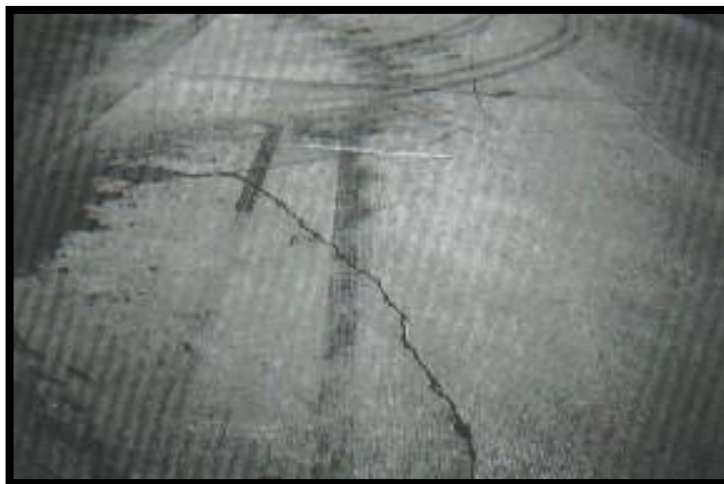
“Losa dividida de baja severidad” ⁽²⁰⁾.
